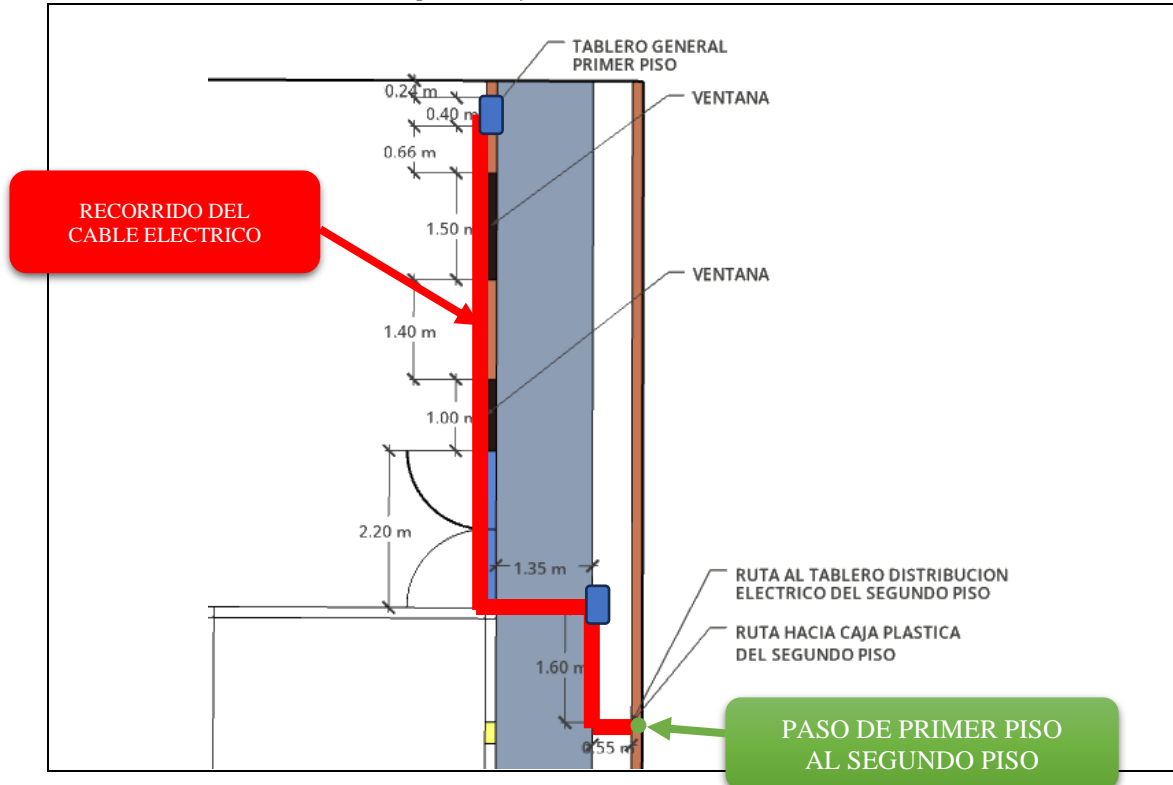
Plano del primer piso para el recorrido instalación del sistema eléctrico.
